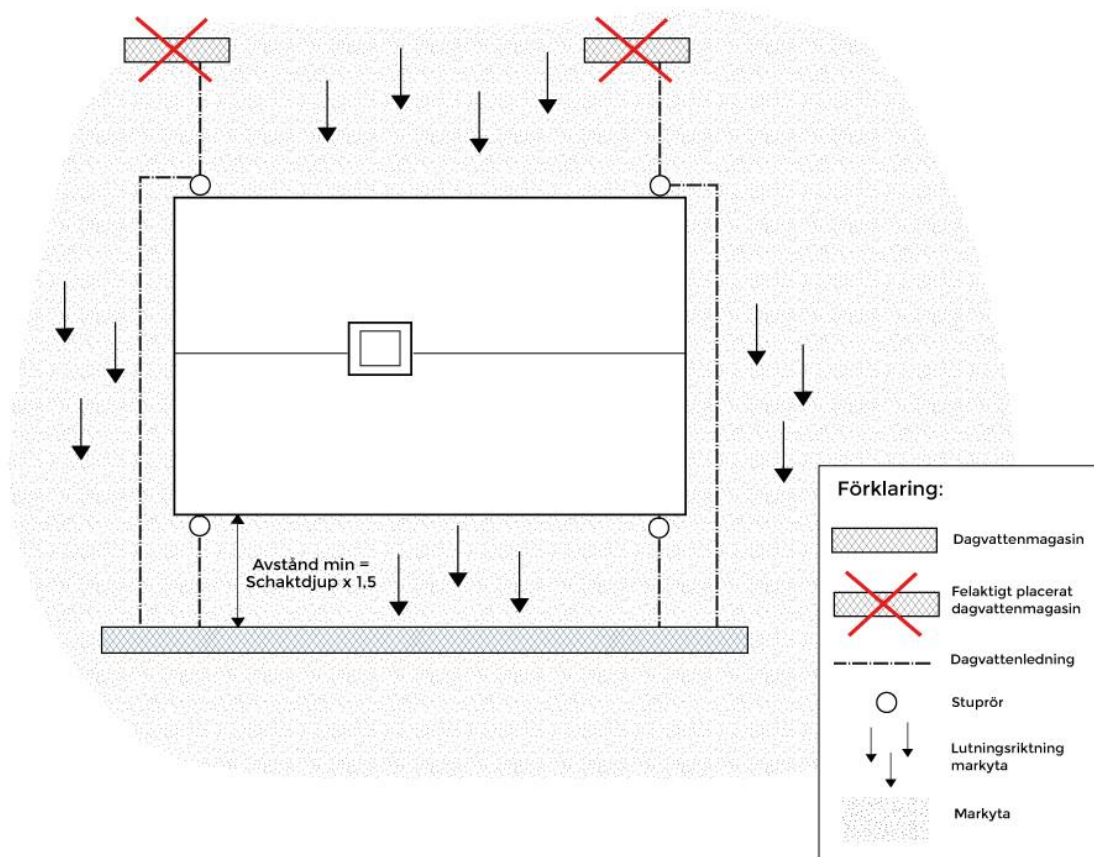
Placering dagvattenmagasin plan mark alternativ 2.
